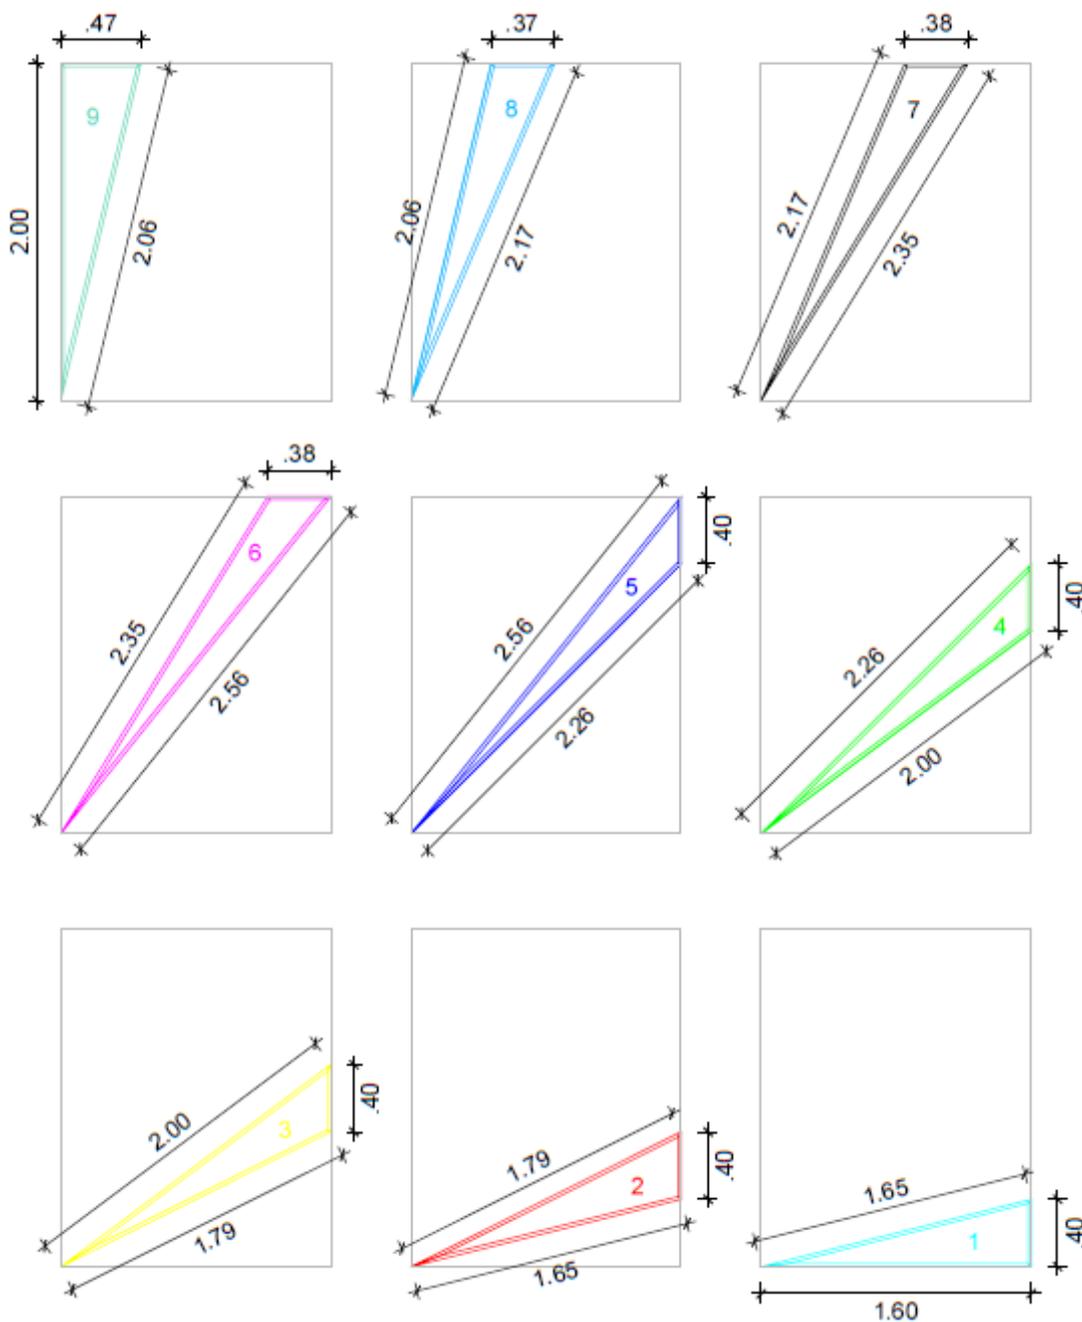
Vista frontal de los paneles con dimensionado y posición de una hoja de la puerta en abanico.
